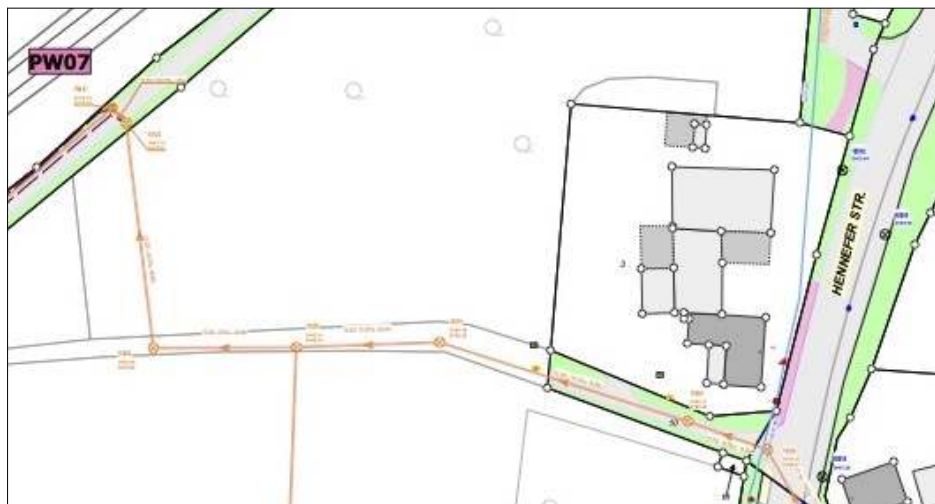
Lageplan / vorhandener Kanalanschluss - Quelle: Gemeinde Eitorf
